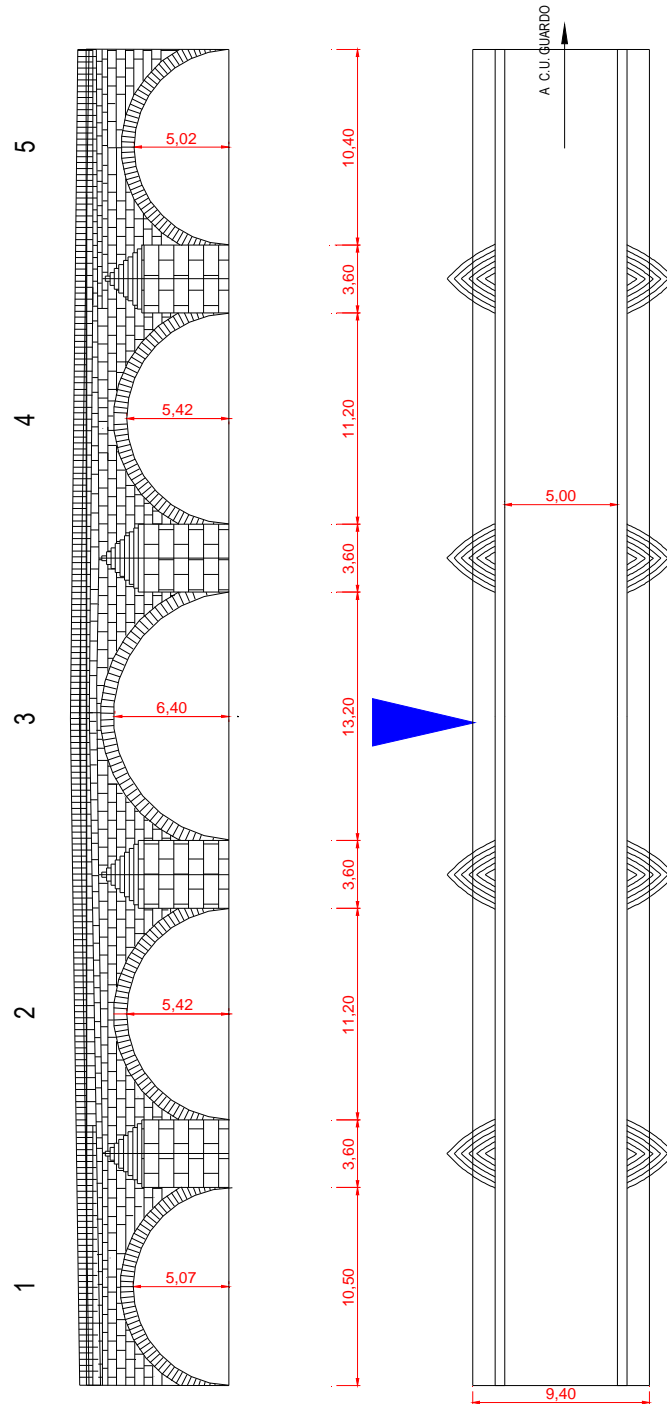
Dibujo de planta y alzado del puente en Guardo.
